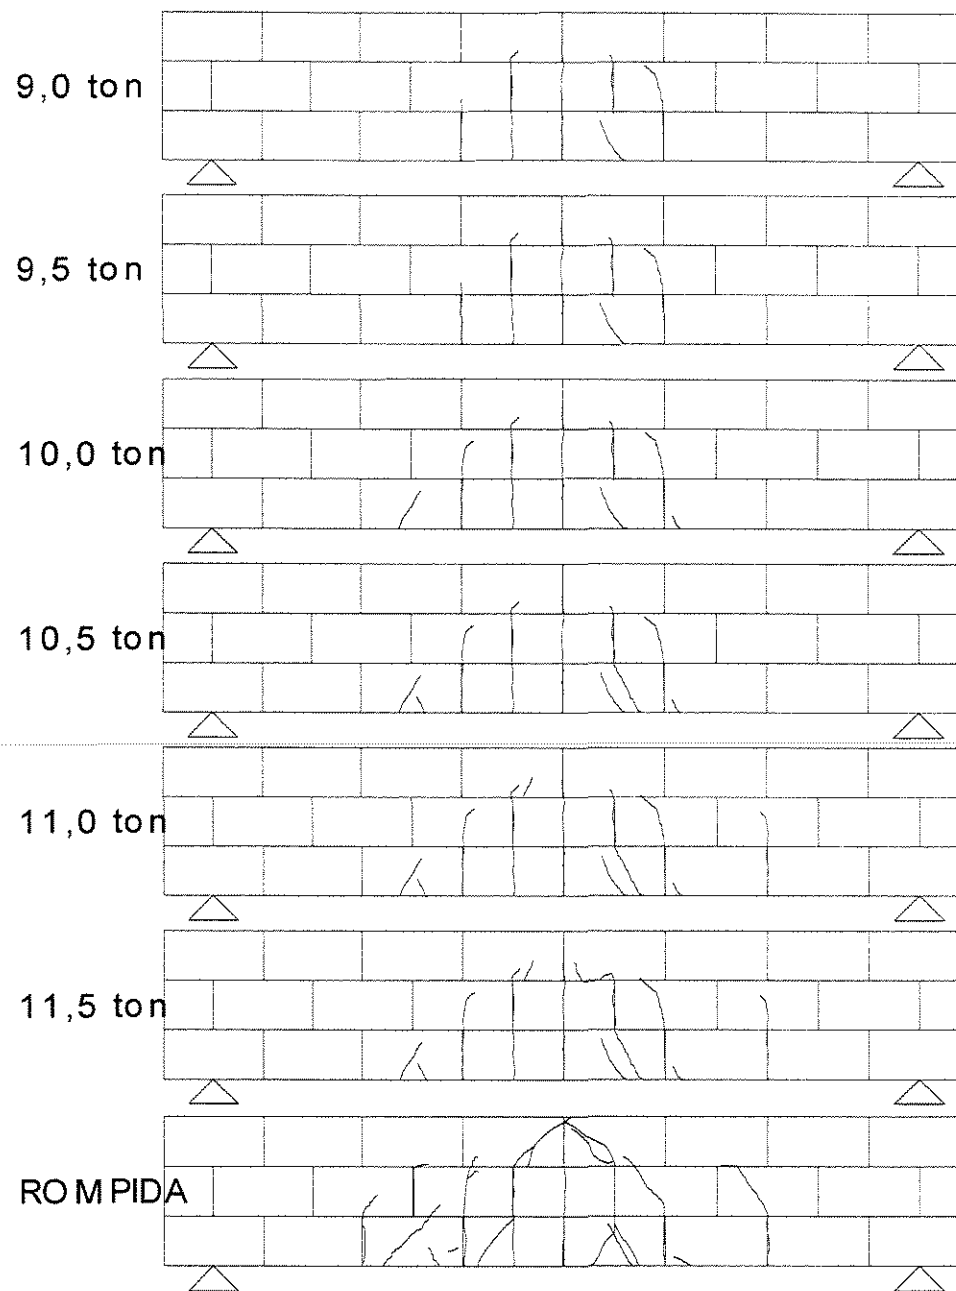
FISSURAS VIGA 3BL-FL
